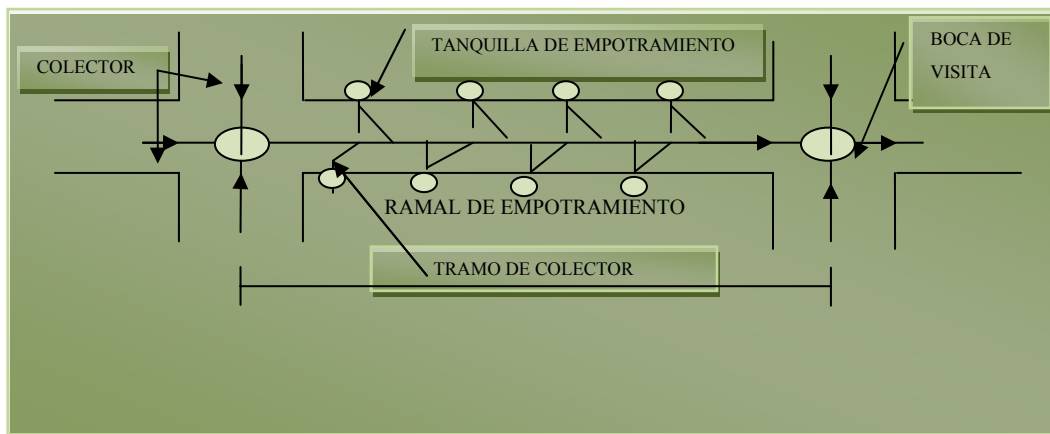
Esquema en planta de la ubicación de las obras de captación en un sistema de aguas residuales.
